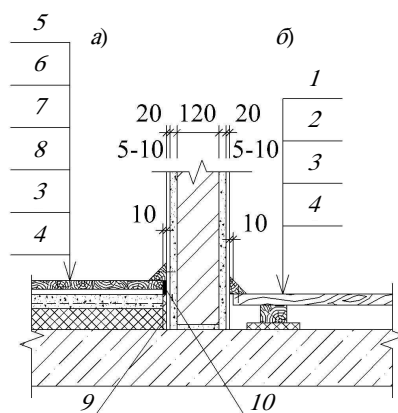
Конструктивные решения узла примыкания пола на звукоизоляционном слое к перегородке (стене):
